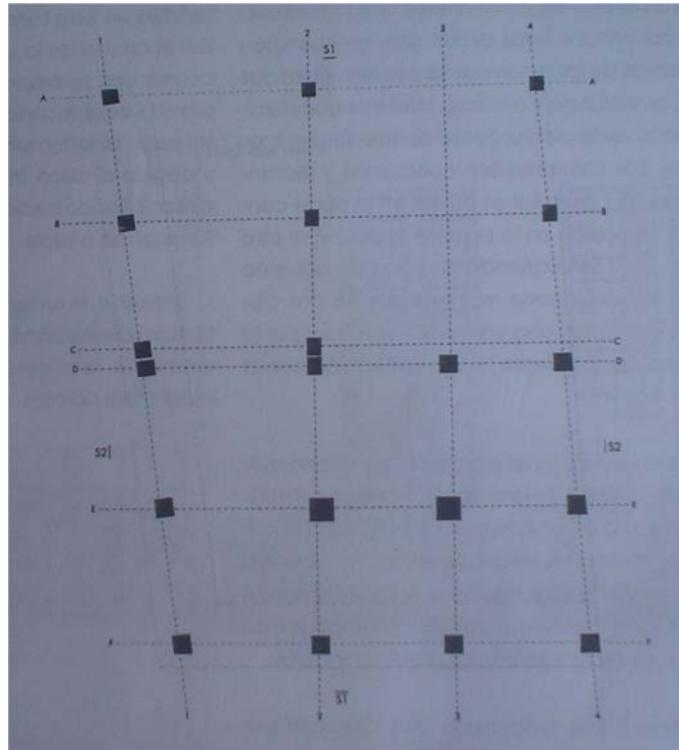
Planta estructural. Fuente: Tesis Lata Guamán, Oswaldo. ALAMIRO GONZÁLEZ. OBRAS Y PROYECTOS ENTRE 1960-1970
